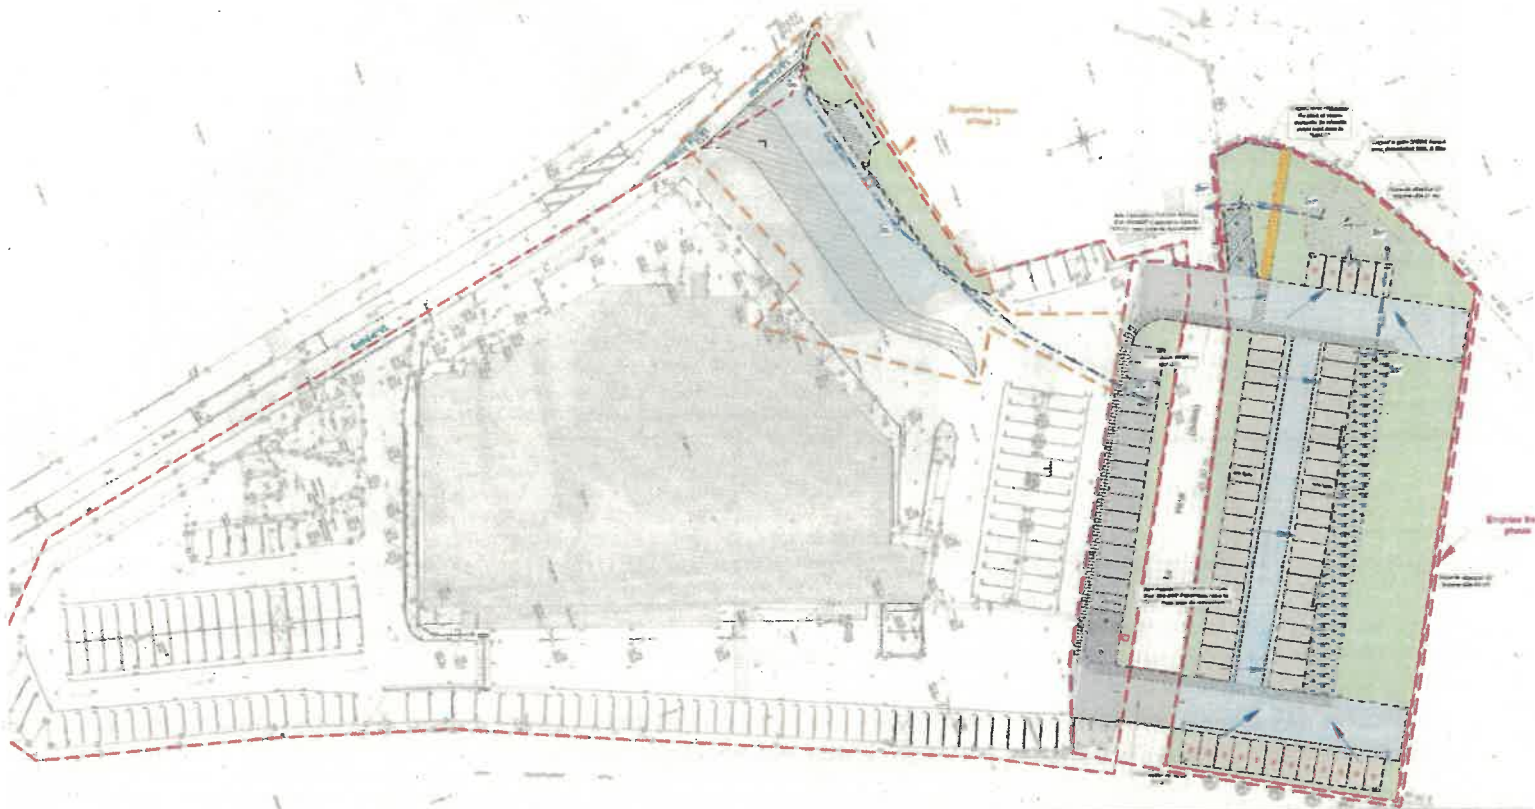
Plan projet VRD sur le supermarché et l'extension du parking
